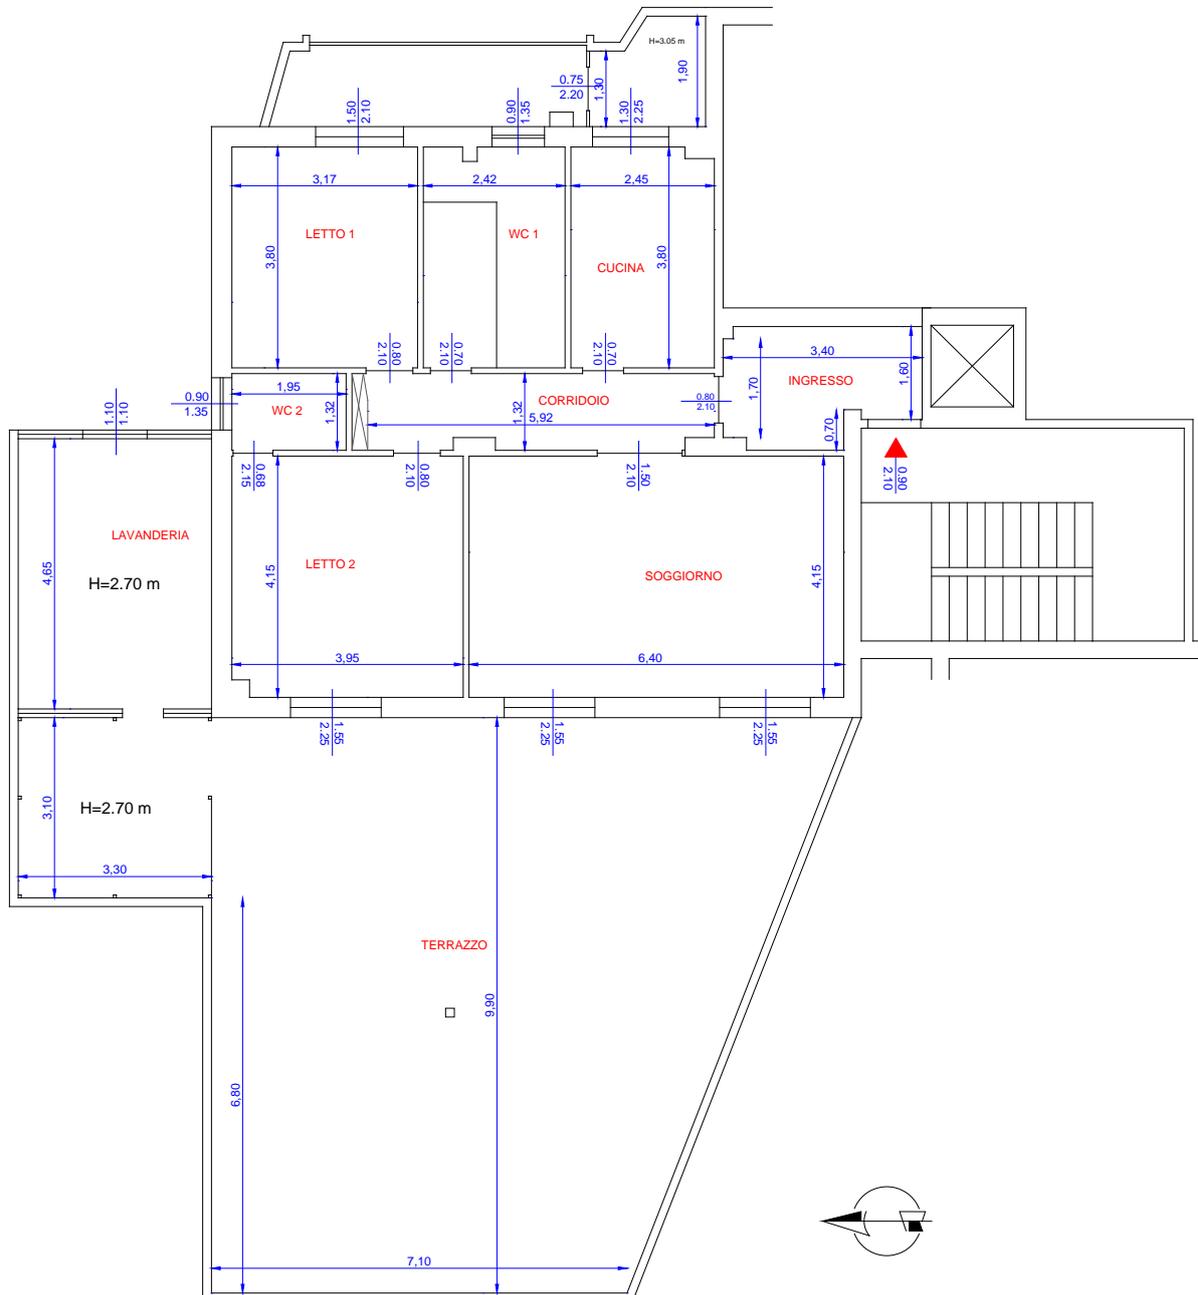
Planimetria da rilievo subalterno 126 (interno 1) – piano primo scala B - particella 329 – foglio 64 – Catanzaro
